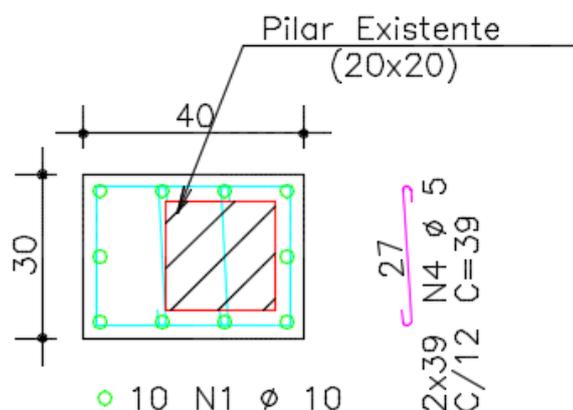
Armadura de Ligação – Pilar existente x Pilar reforçado
